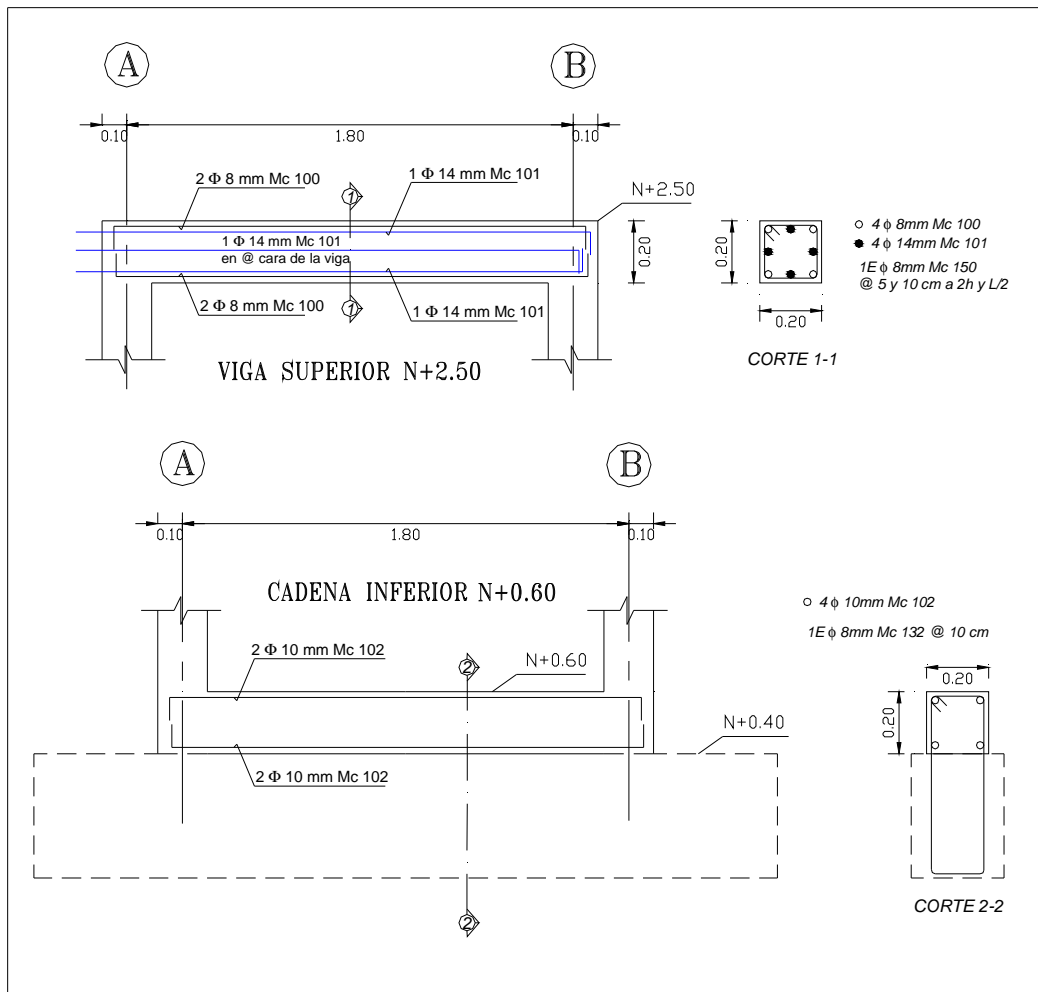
Diseño estructural del Pórtico Tipo de H.A. Viga superior y cadena
